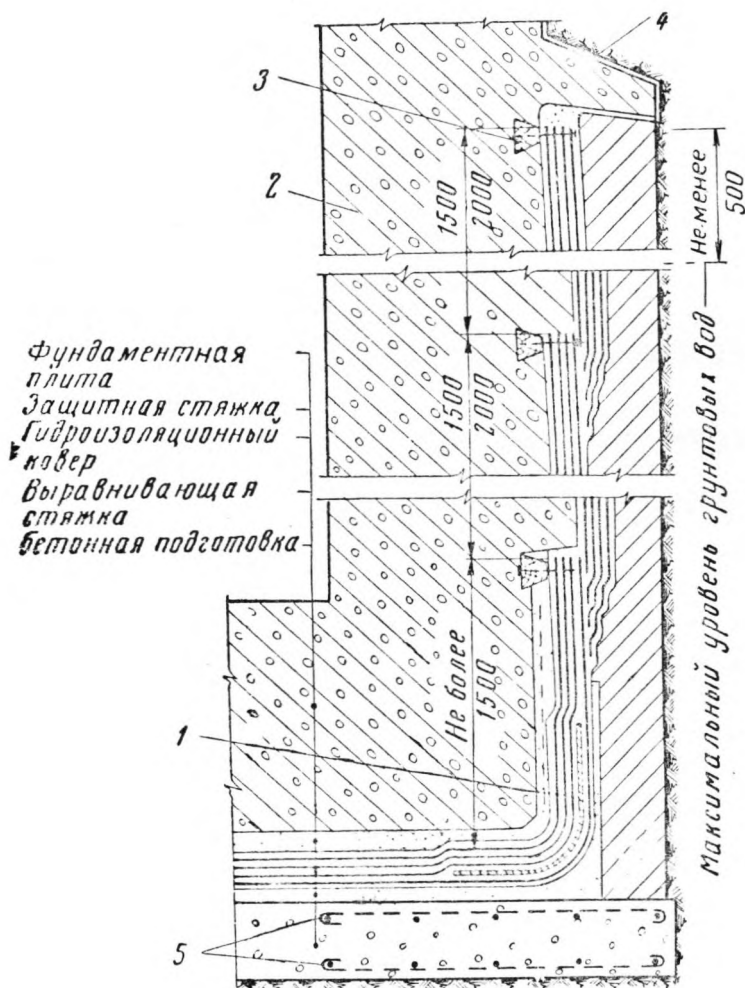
Крепление гидроизоляционного ковра, наклеиваемого на несущую конструкцию на вертикальные стены
